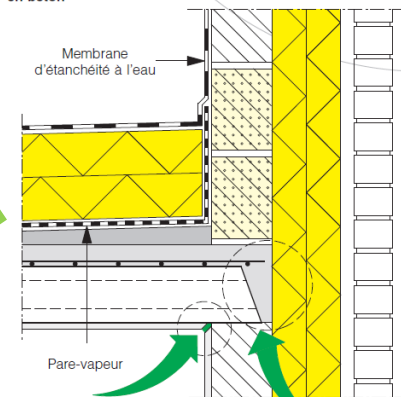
Continuité de l'étanchéité à l'air des planchers de toiture en béton
